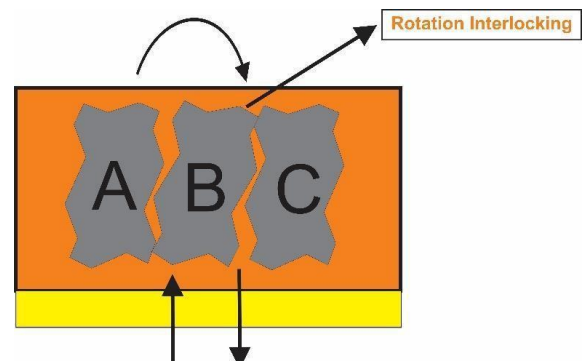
Pembebanan Horizontal pada Paving Block Bata
